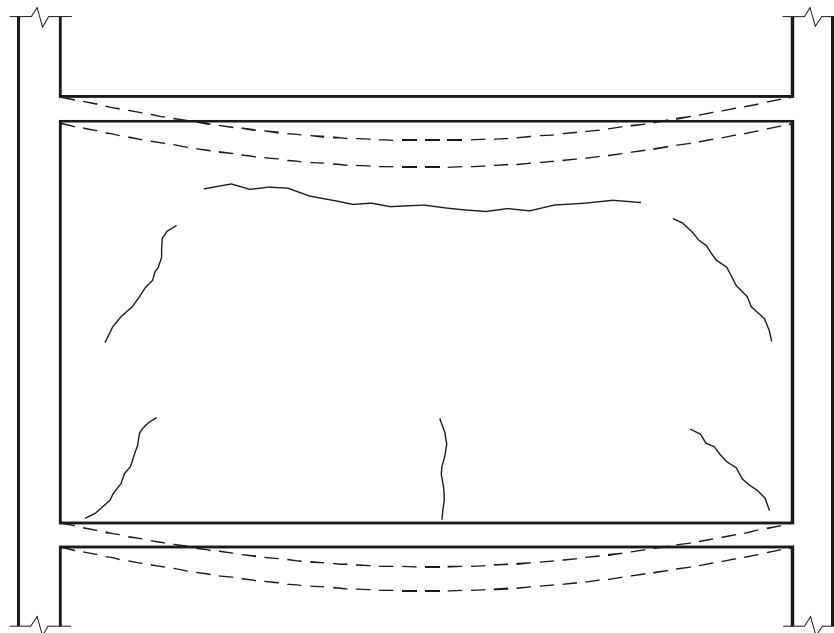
Fissuramento em painéis de alvenaria causado pela excessiva deformação de lajes e vigas. A configuração varia em função dos valores das flechas desenvolvidas.
